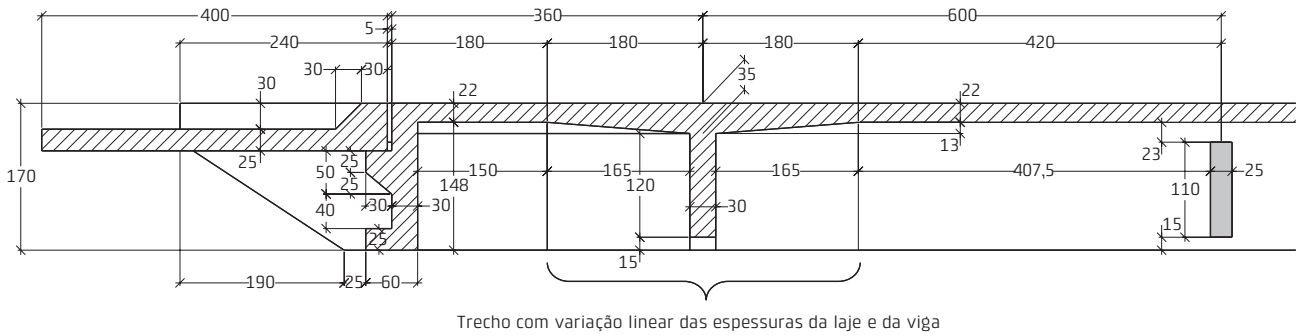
Detalhe do corte longitudinal – medidas em cm
